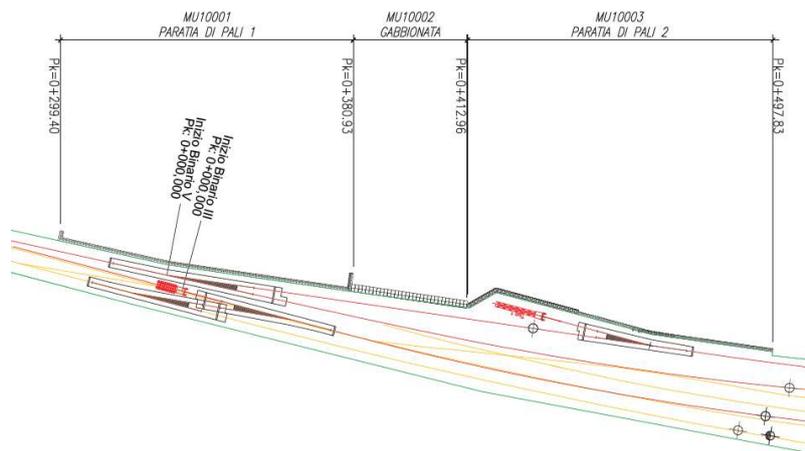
Opere di sostegno – Stralci planimetrico (1)
